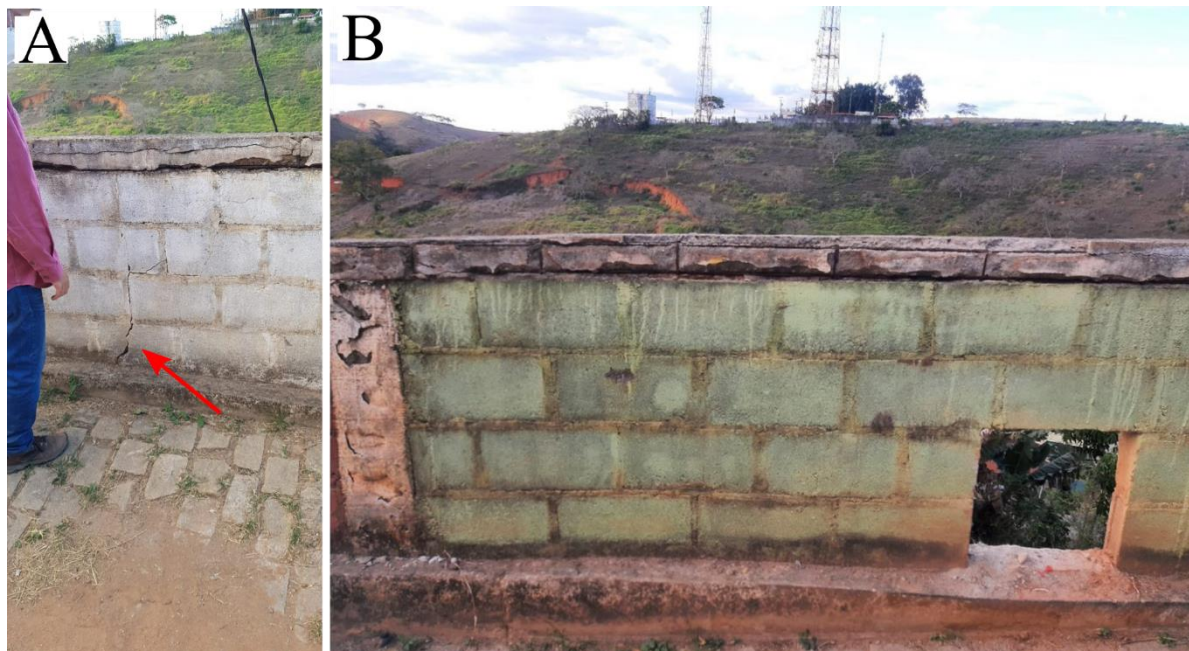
Muro de concreto próximo a Travessa. A) Rachaduras e trincas indicadas pela seta vermelha; B) Deslocamento do concreto.
